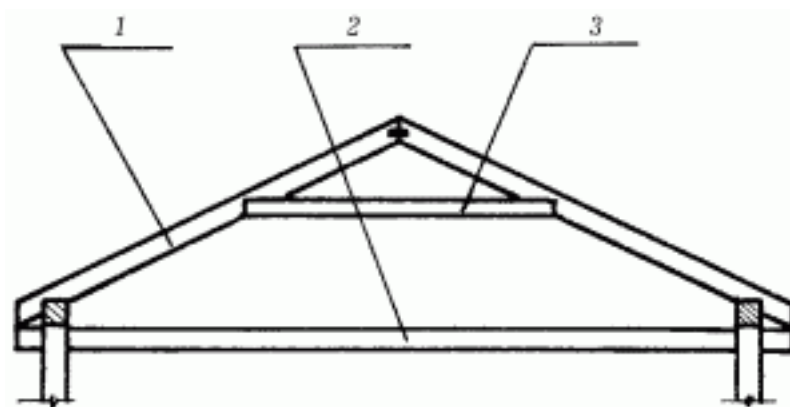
Наслонные стропила: 1 – стропильная нога; 2 – ригель; 3 – чердачное перекрытие.
